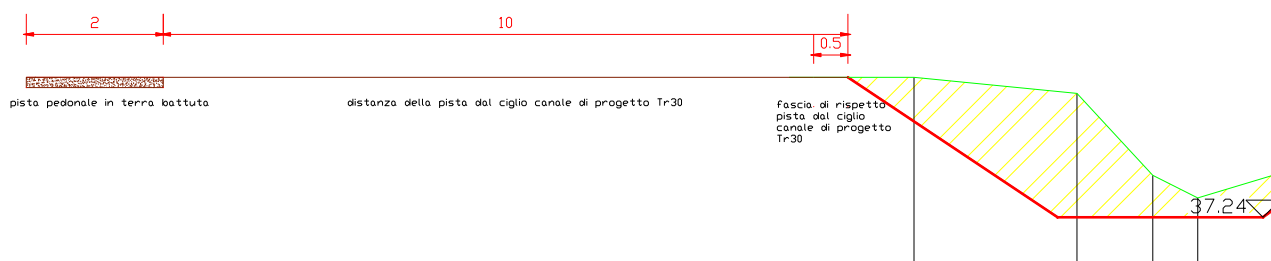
PARTICOLARE DELLA DISTANZA DELLA PISTA DAL CIGLIO CANALE DI PROGETTO TR30
